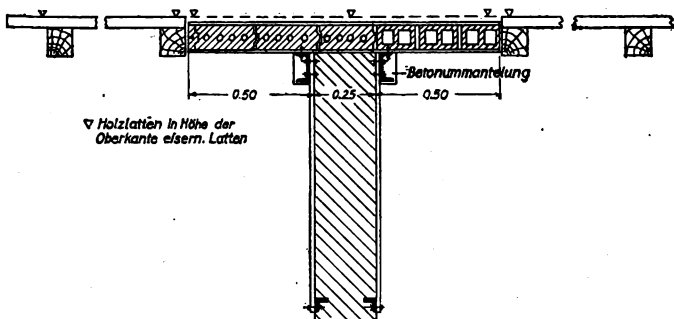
Dachdeckung aus Hohlsteinen mit Brandmauer
